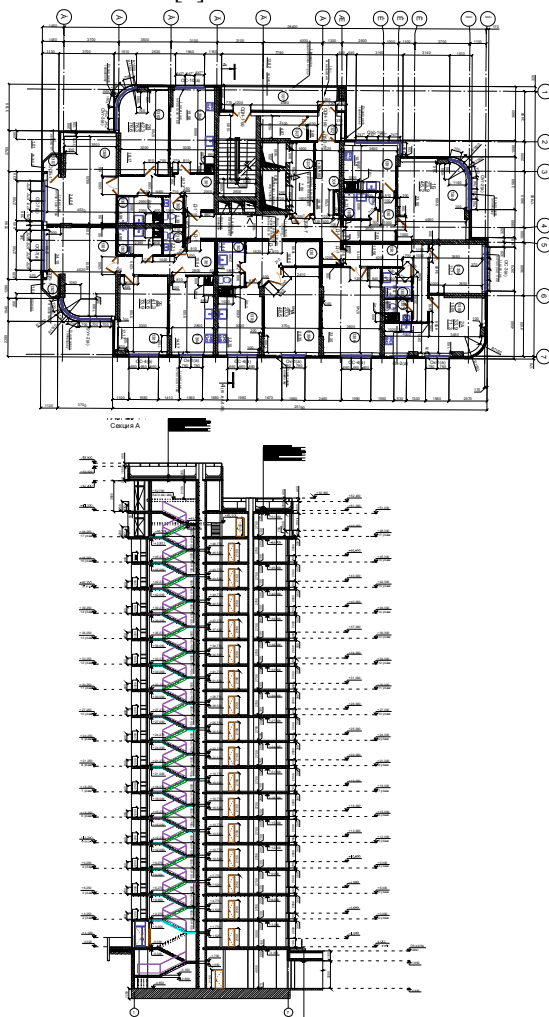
План и разрез строящегося здания, на ул. Средняя
